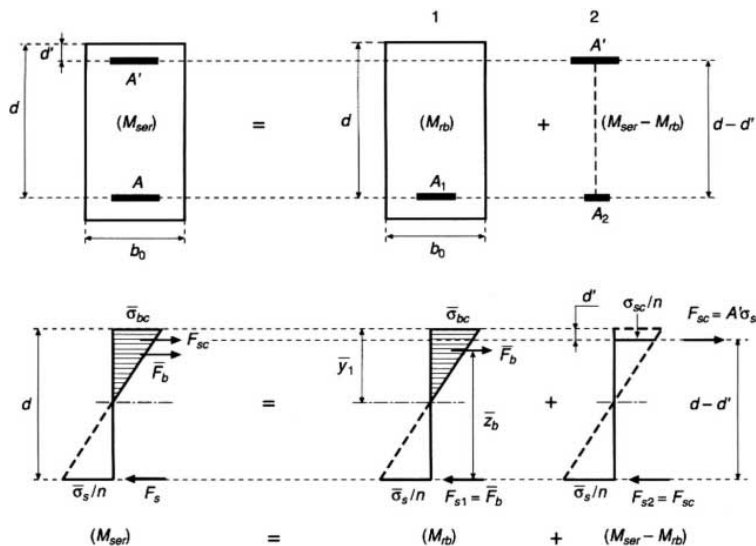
Principe de calcul à l'ELS, d'une section en T avec armatures comprimées
